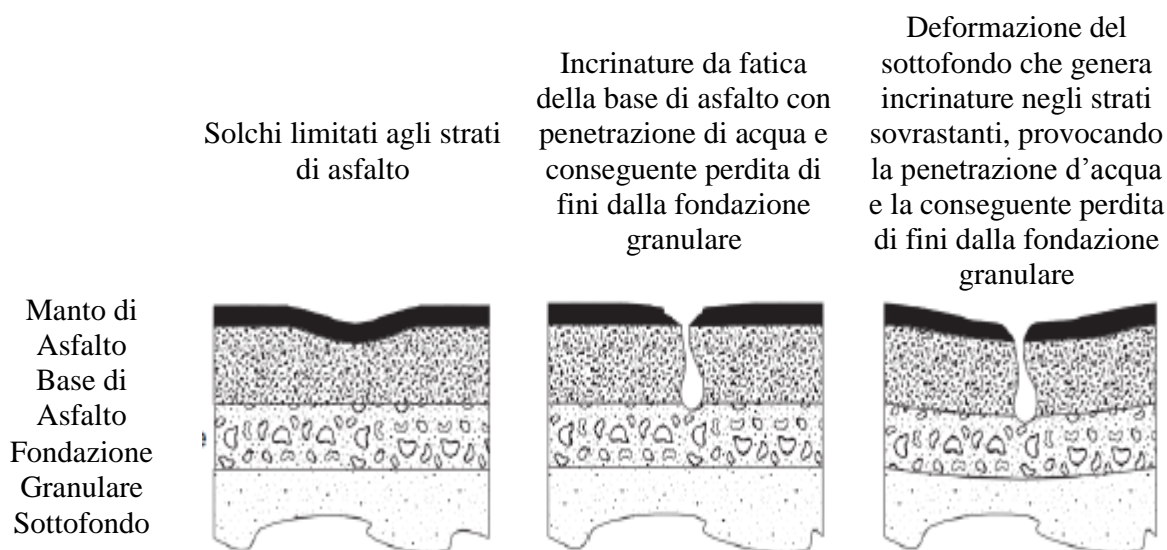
9: Forme di Deterioramento della Pavimentazione Stradale
